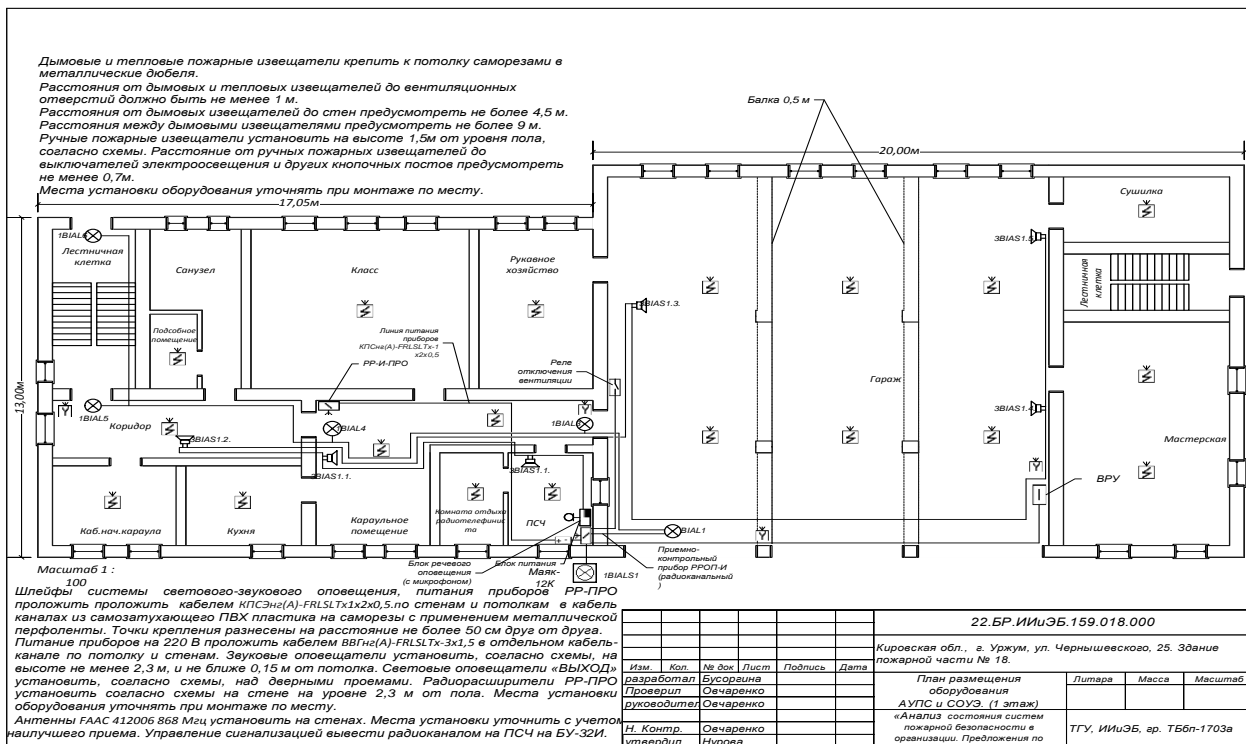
План размещения оборудования АУПС 1 этаж
